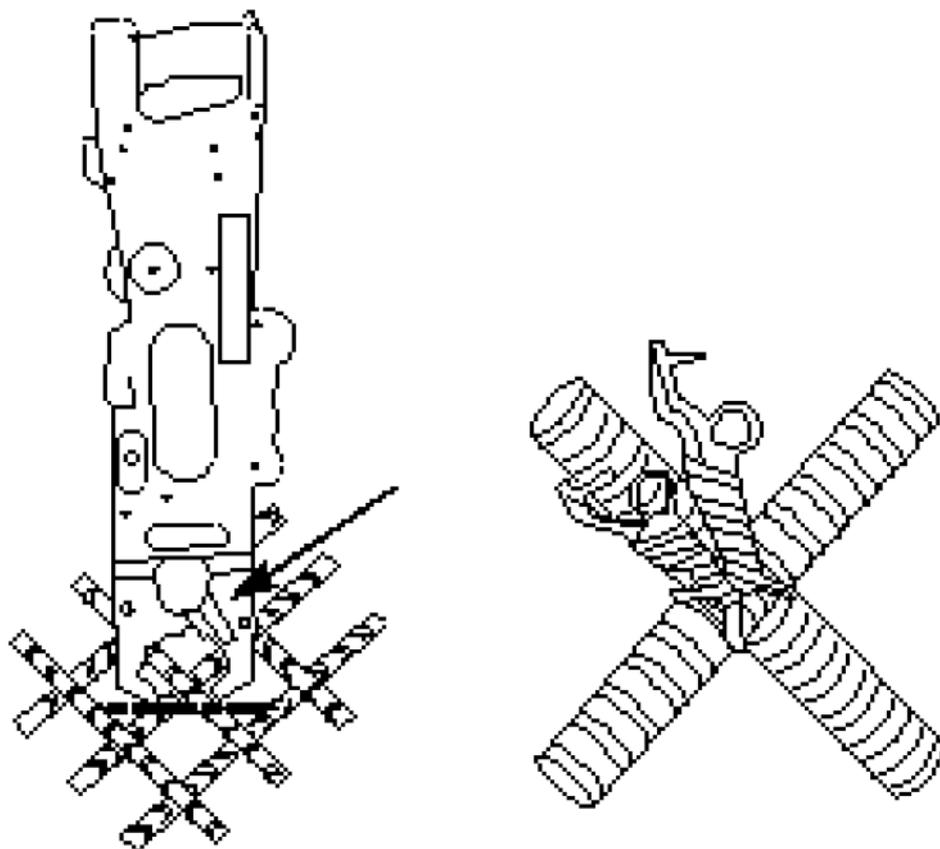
Схема механизированной вязки арматуры пистолетами
